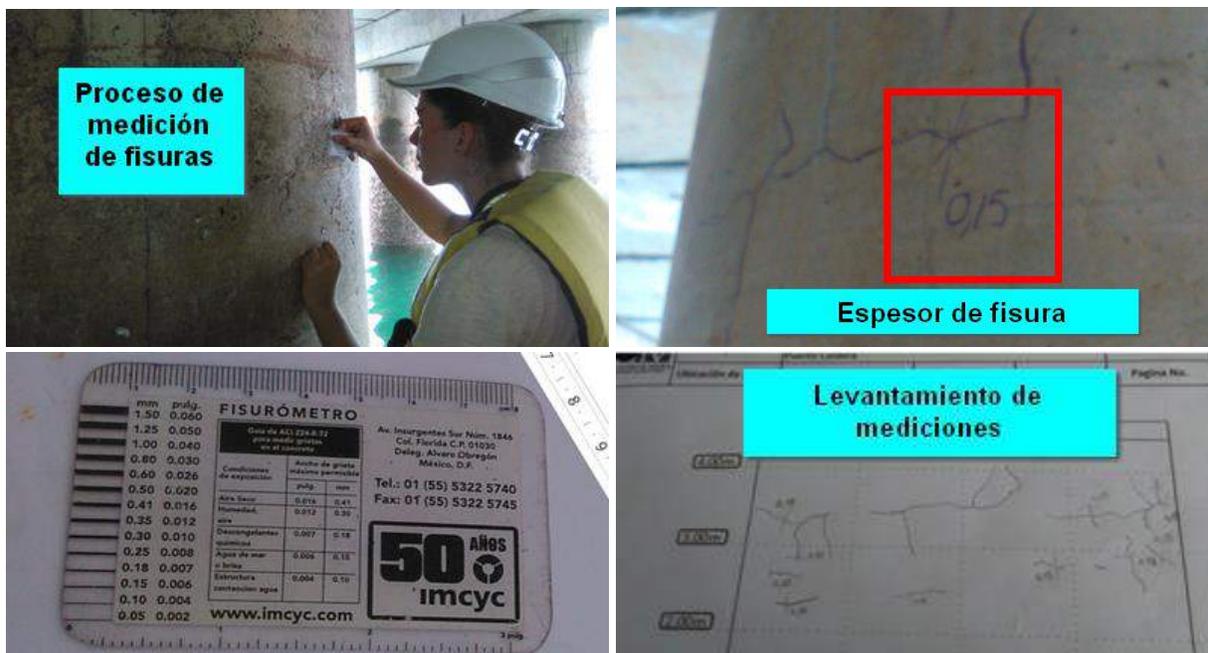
Limpieza y medición de fisuras de mangas de concreto
